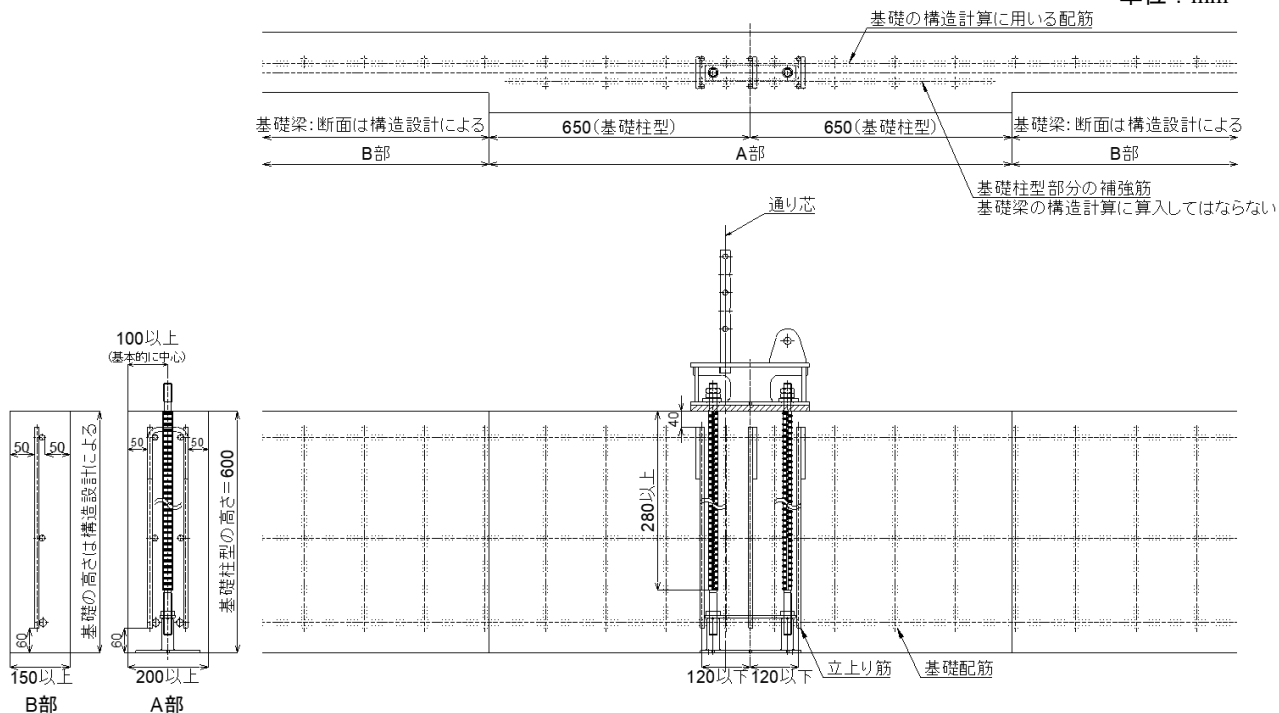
基礎柱型配筋例 (中柱 シングル配筋の計画例)
